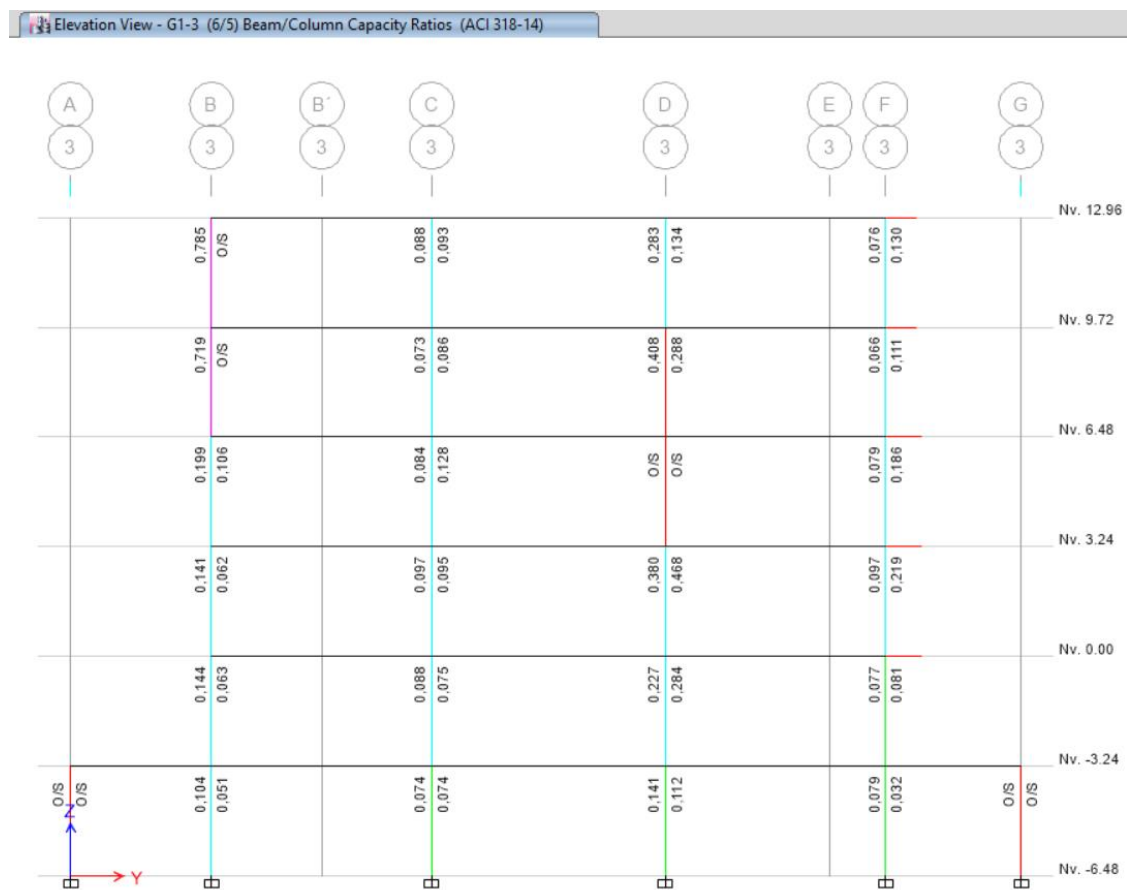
Vista en elevación de factor de capacidad unión viga-columnas, pórtico eje 2.
